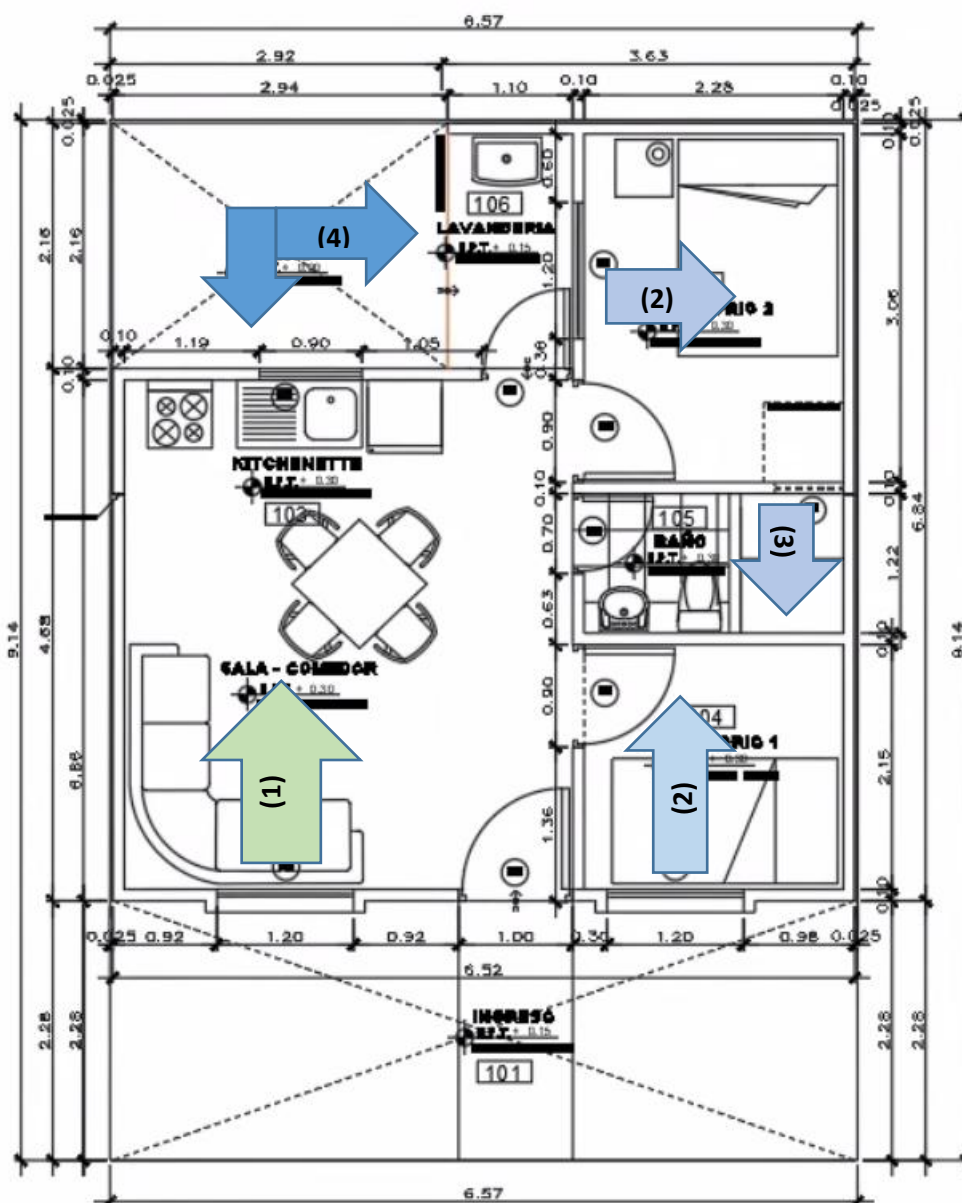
Detalle en planta del sistema de ventilación de la vivienda
